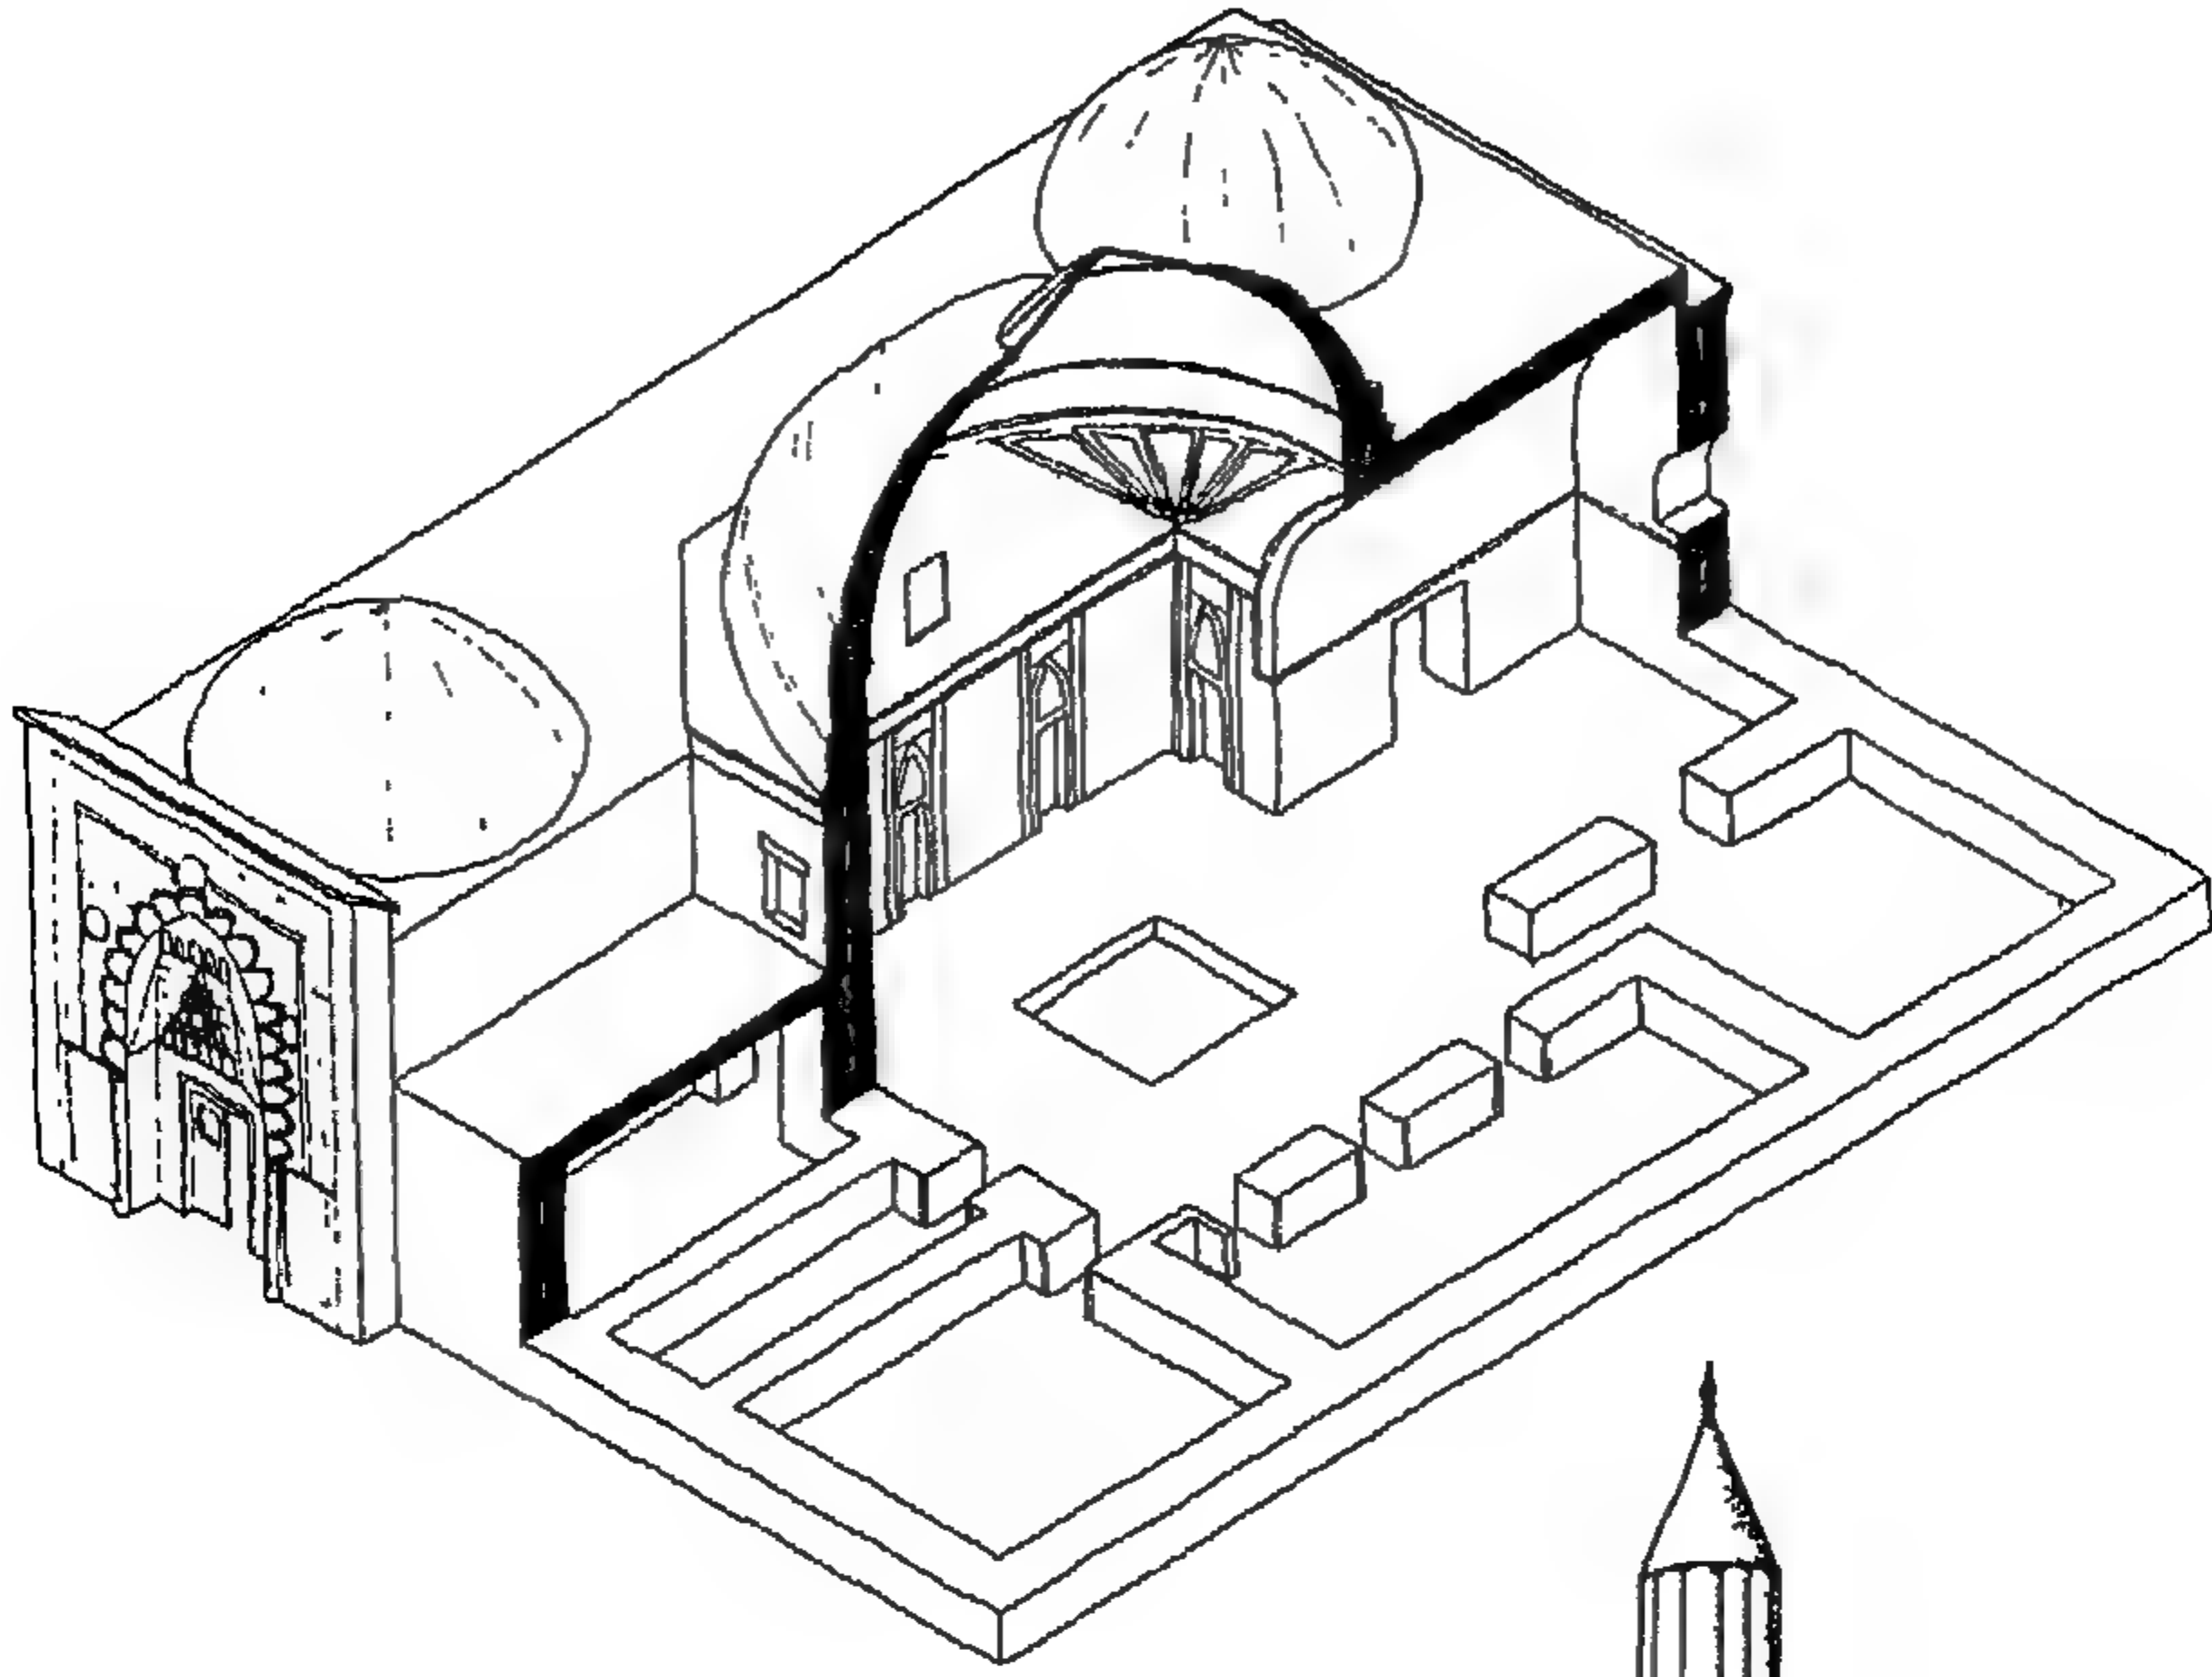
مسقط أفقي لمدرسة ياغي باسان في تكسار . (عن : جابرييل) .
